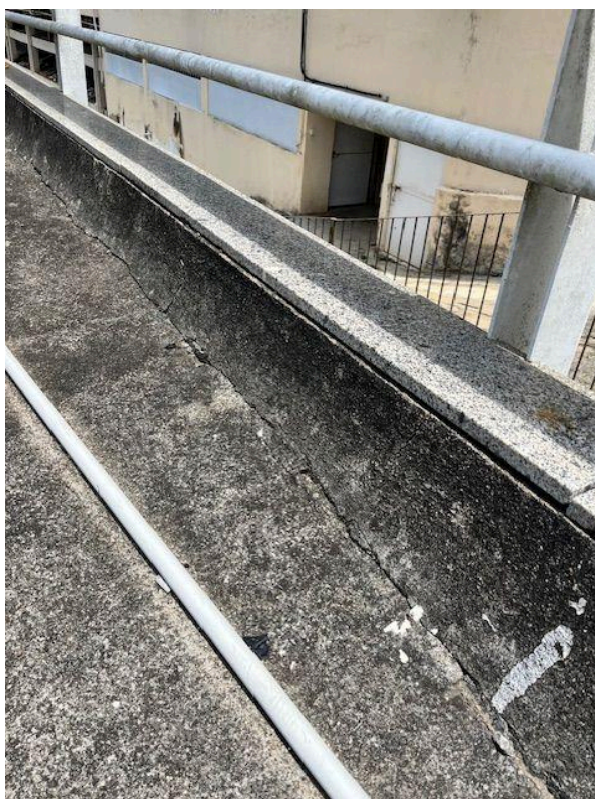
Marcação 2.15 - Fissura na parede externa do subsolo.
